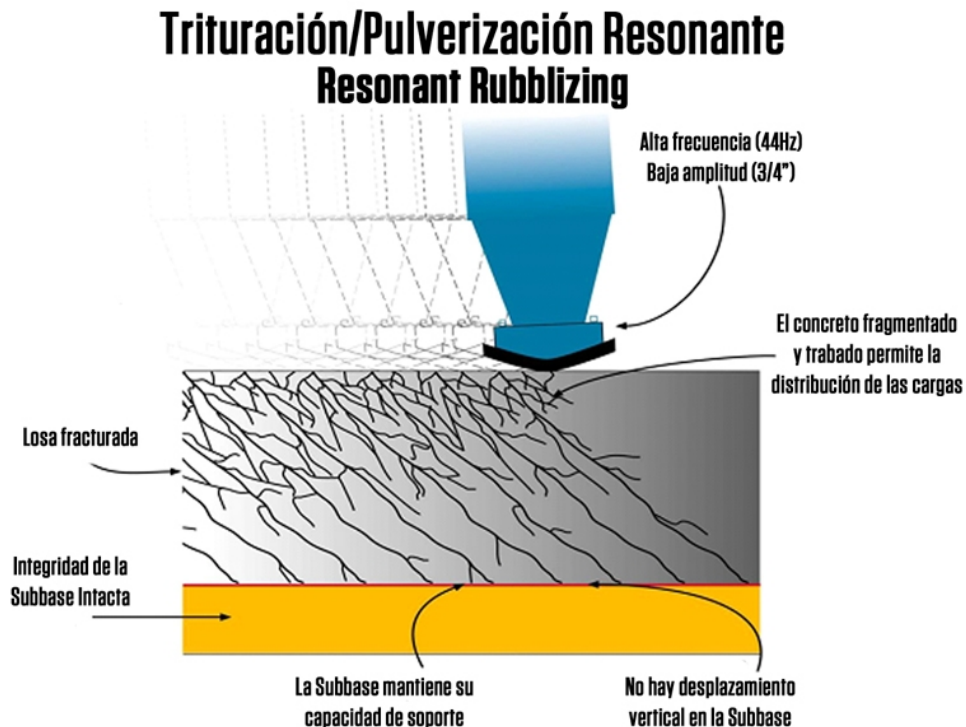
Patrón de fracturamiento de una losa de concreto en un pavimento, utilizando equipo rompedor de frecuencia resonante (RMI, Inc.).
